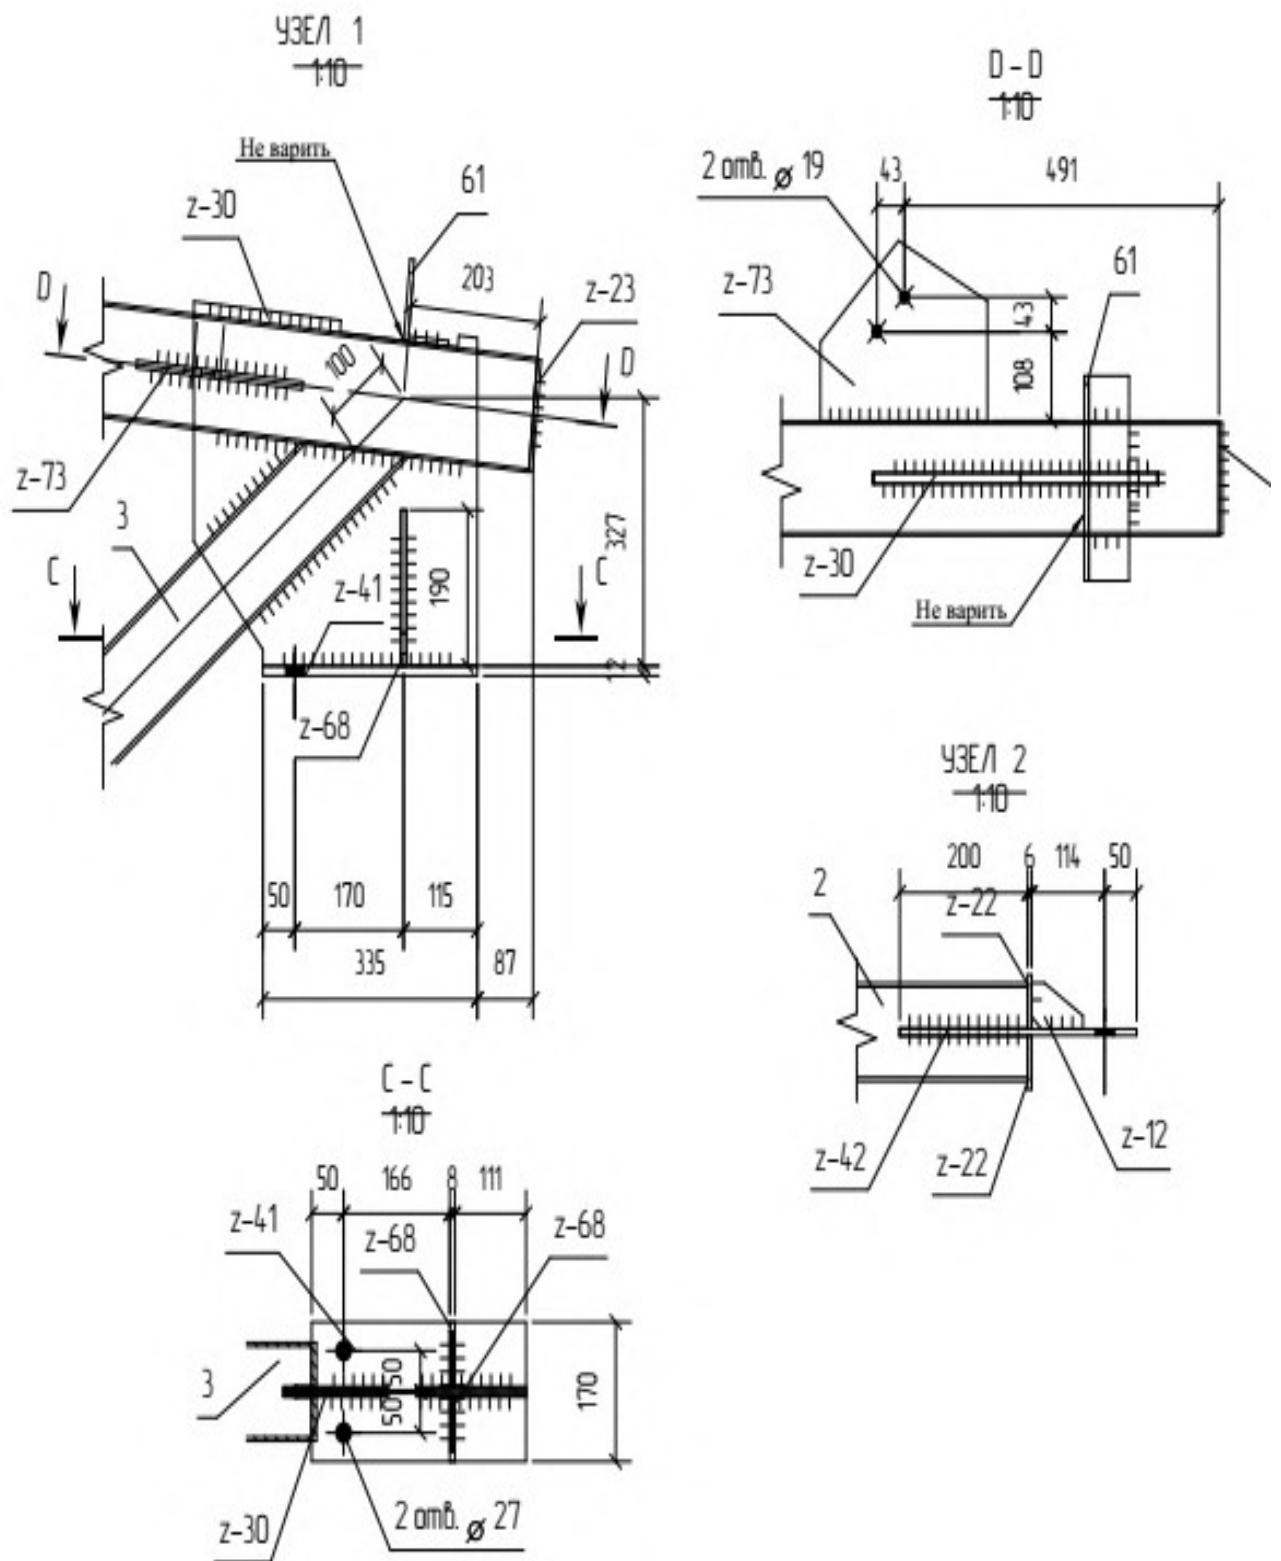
Фрагмент елементів кровляної ферми
